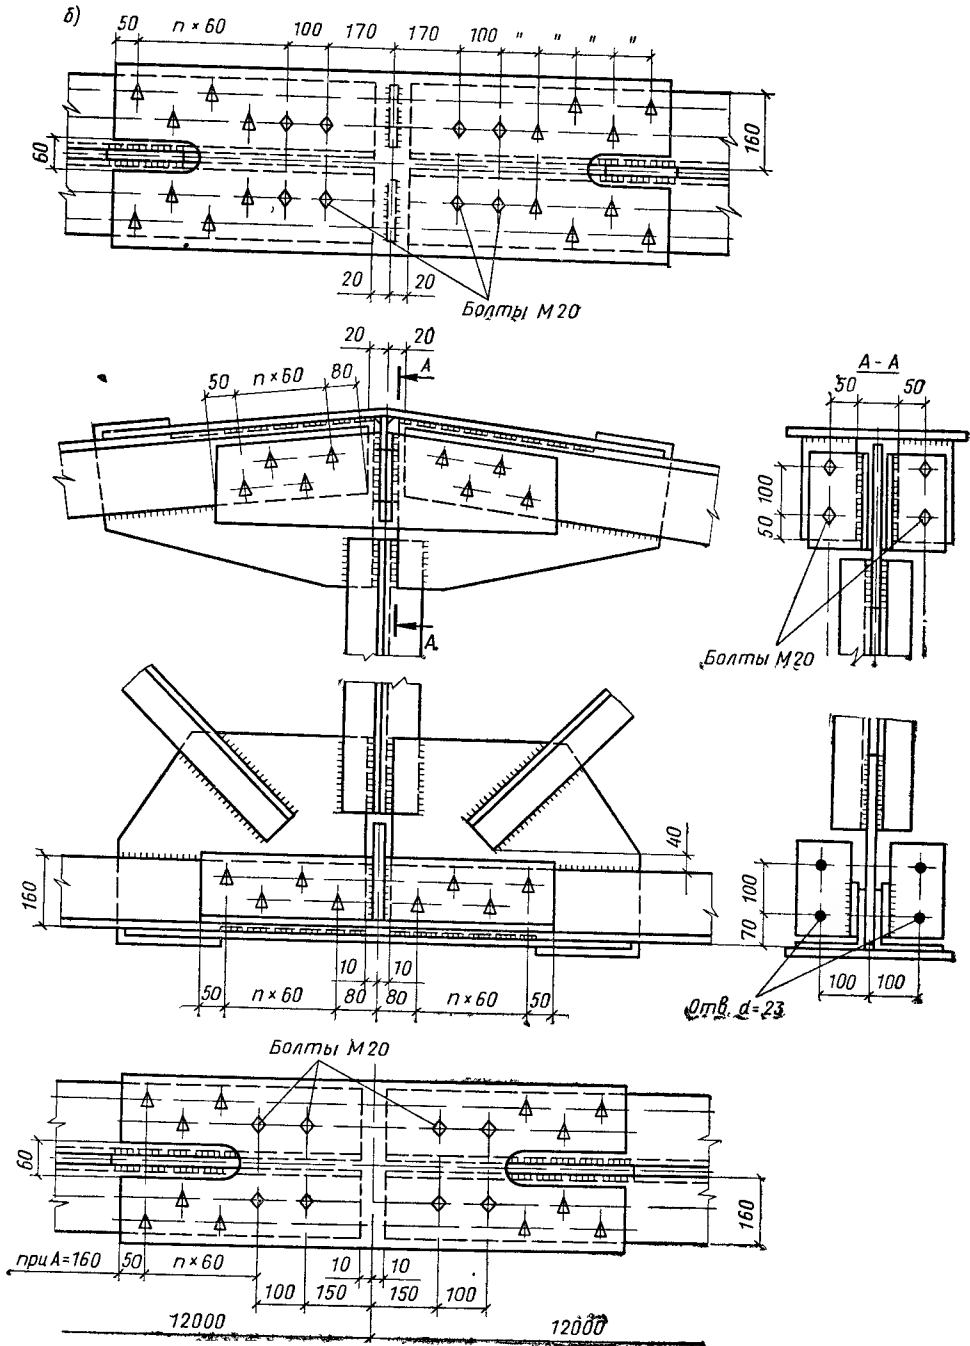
Укрупнительный стык стропильной фермы из парных уголков
